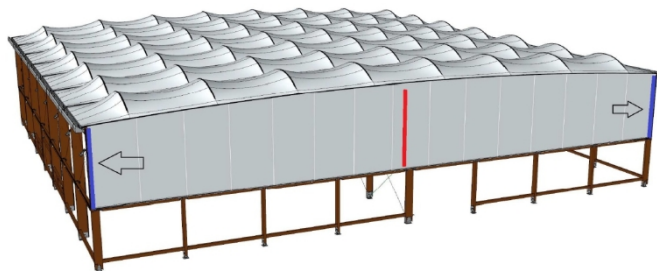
Façade textile long pan – repérage des types de fixation
